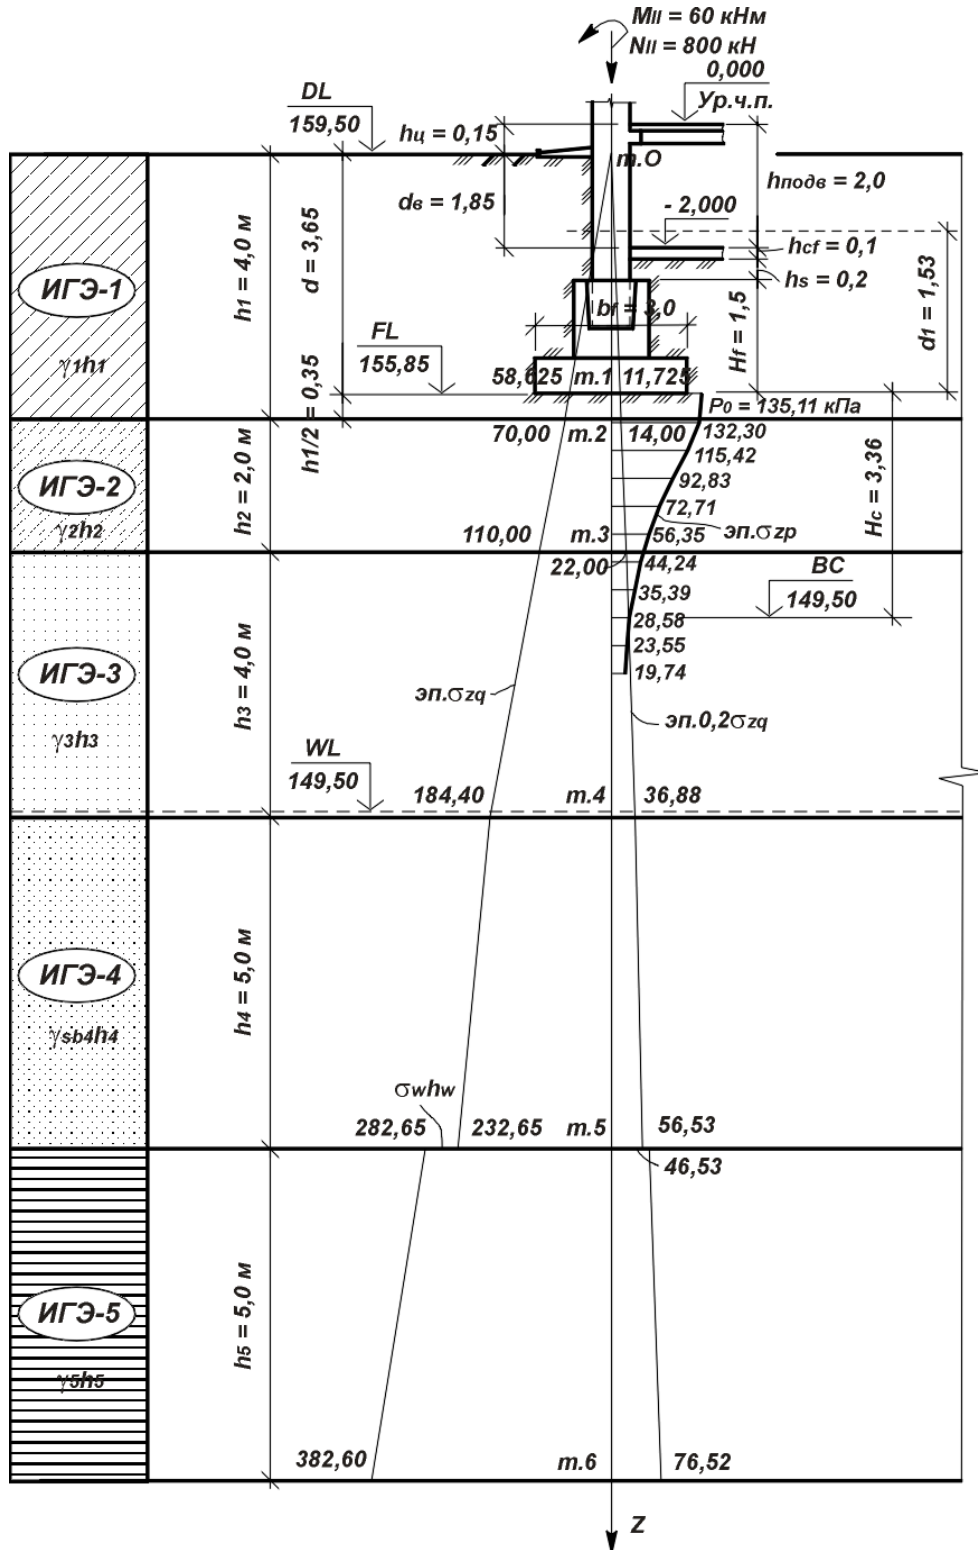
К расчету осадки фундамента ФМЗ-1 в сечении I-I (А-7): DL – отметка планировки; NL – отметка природного рельефа; FL – отметка подошвы фундамента; WL – уровень подземных вод; BC – нижняя граница сжимаемой толщи; H_c – толщина сжимаемой толщи; d_1 – глубина заложения фундамента от уровня планировки; b_f – ширина фундамента; $эп. \sigma_{zg}$ и $эп. 0,2 \sigma_{zg}$ – соответственно, основная и вспомогательная эпюры вертикальных напряжений от собственного веса грунта; $эп. \sigma_{zp}$ – эпюра дополнительного вертикального напряжения от подошвы фундамента
